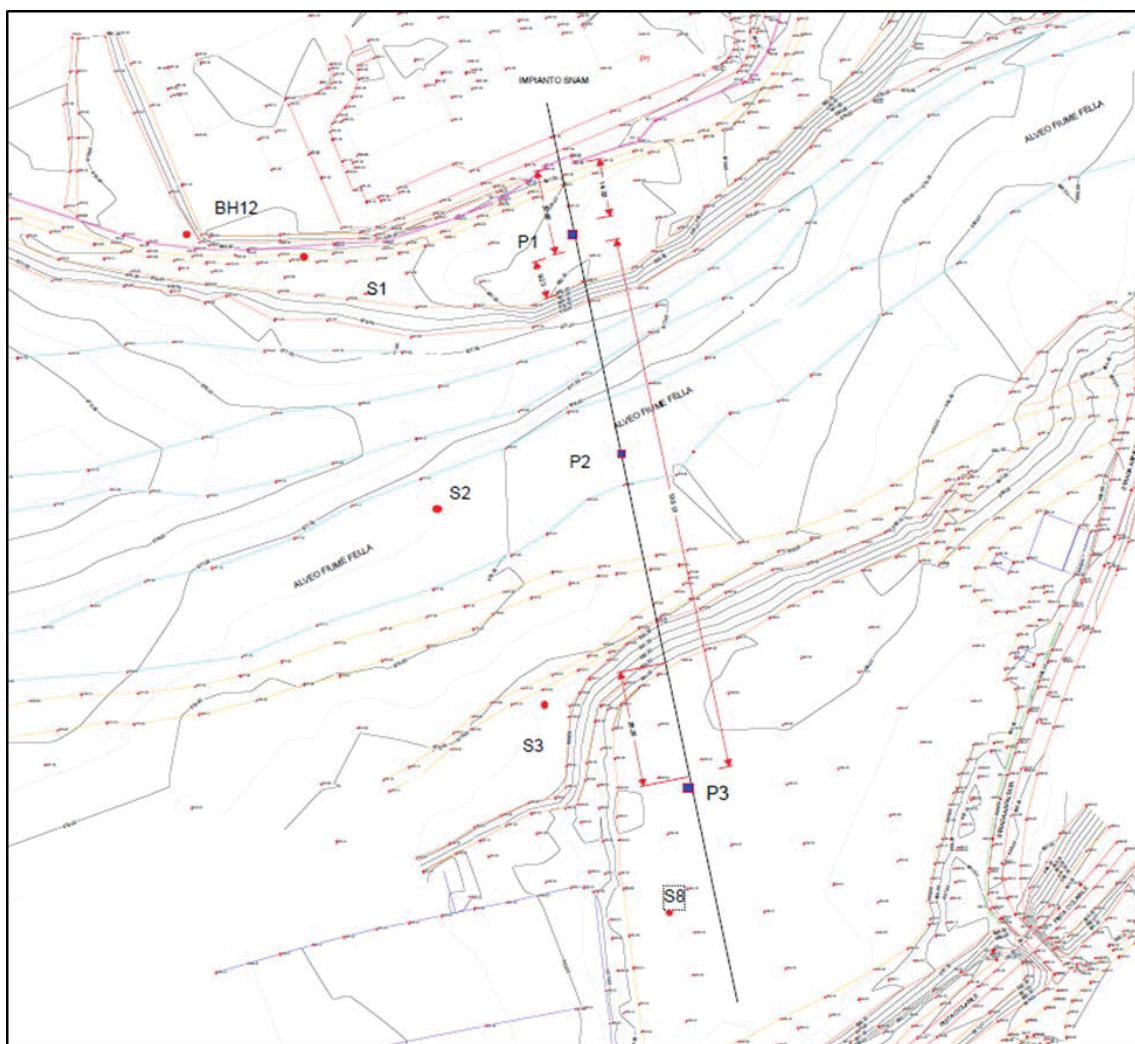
/A – Planimetria con ubicazione dell’attraversamento e dei sondaggi a carotaggio
